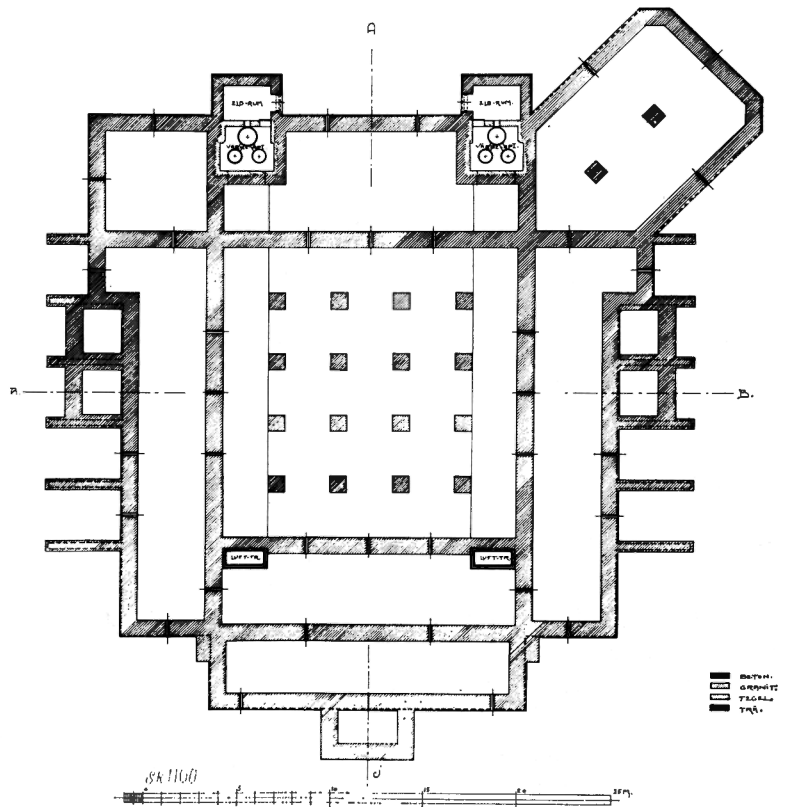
Plan av grund, kyrkorum och takstol, oktober 1908, Riksarkivet. Kyrkorummets plan överensstämmer ej med det befintliga skicket på följande punkter. Väggan bakom altaret är murad och en snedsträva skjuter ut mitt för altaret. Trappan till koret har gjorts bredare och altarrundelns form har ändrats, Predikstolens trappa följer sakristians västra vägg, som har två öppningar mot kyrkorummet. De två översta bänkraderna har utgått, och trappan till läktaren förlagts till förrådet med ett rektangulärt lopp. Den södra delen av förrummet och förrådet har tagits i anspråk för brudkammaren.
